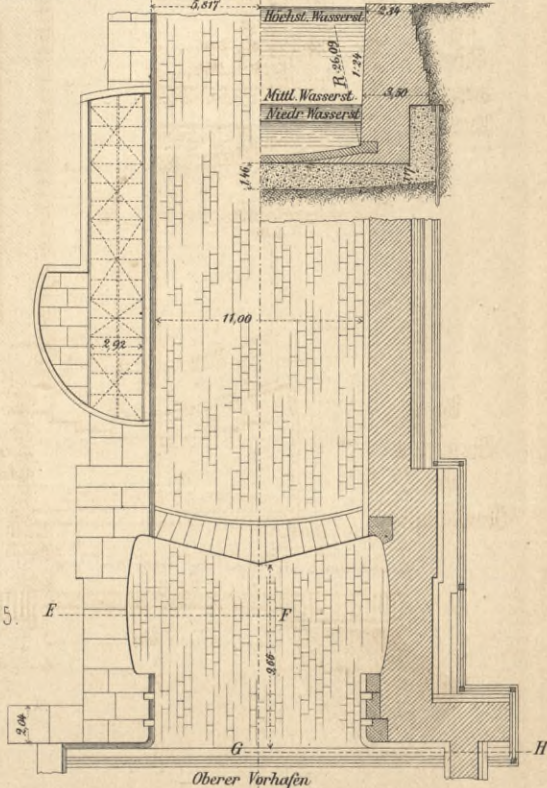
Grundriss d. Oberhauptes; Schnitt durch d. Kammer.
